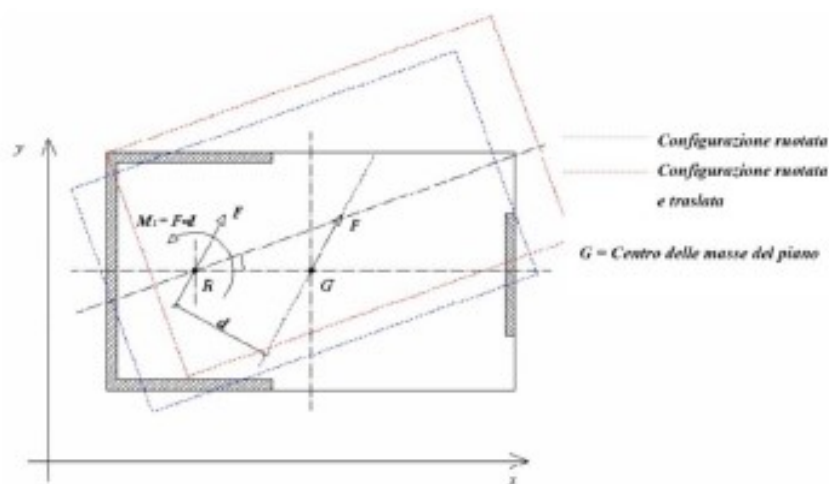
Sistema spaziale di controventamento geometricamente asimmetrico in pianta
